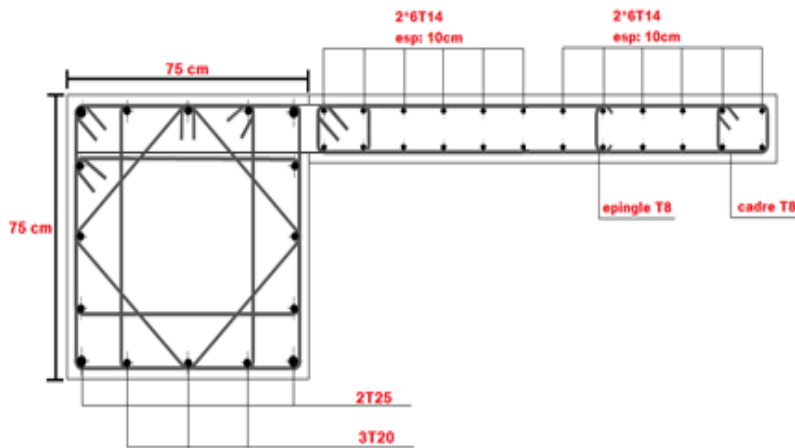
ferrailage de voile Vx1 (RDC...4^{ème} étage)
